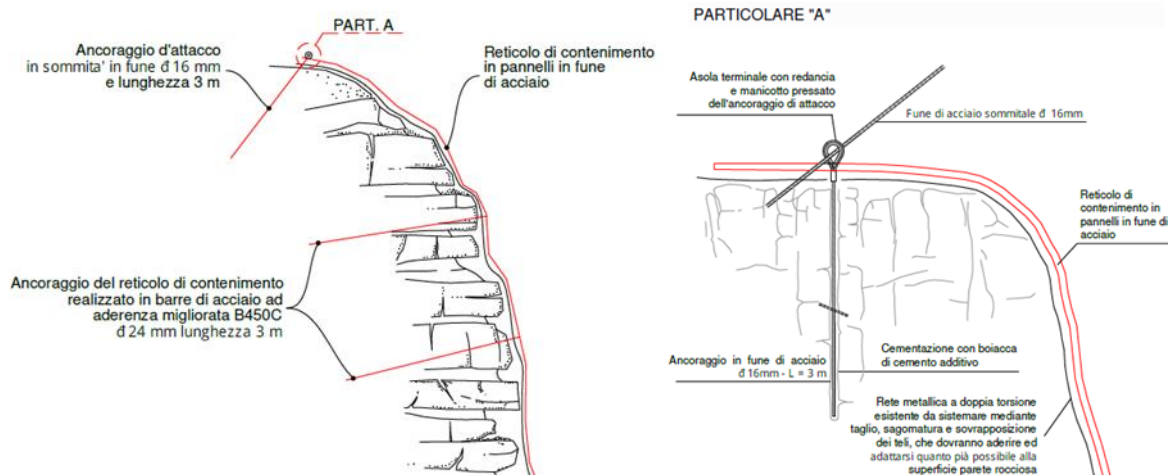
Sezione parziale rafforzamento corticale con particolare ancoraggio di attacco
